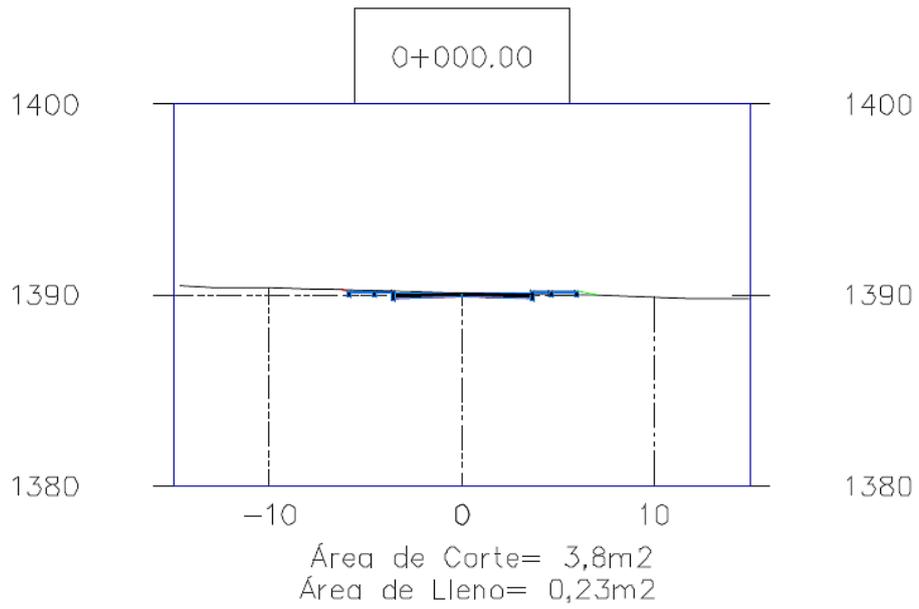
Sección Transversal, abscisa 0+000. Elaboración Propia
